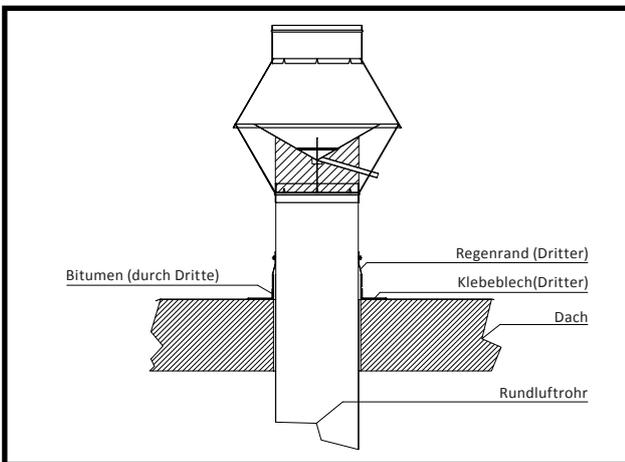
SK-1 auf dem Dach an Rohr aus dem Dach
